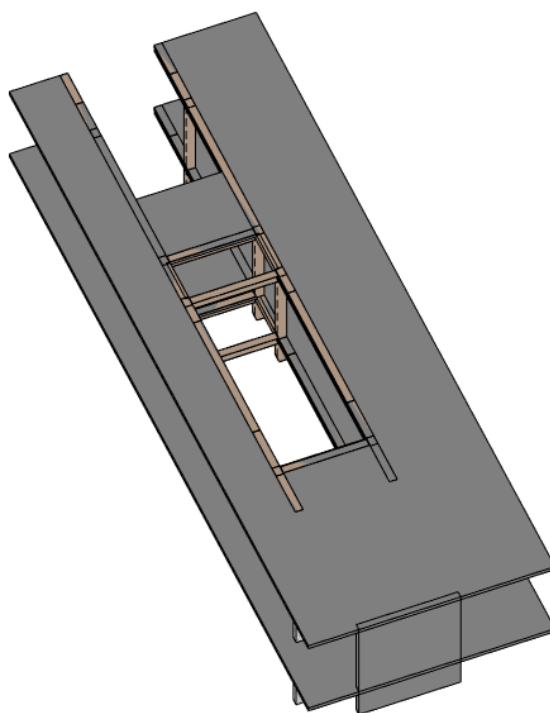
Pormenor da sobreposição de elementos em LOD 200.
